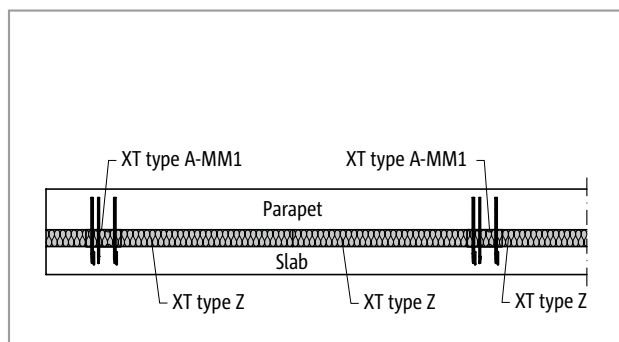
Schöck Isokorb® XT type A, Z: Attic (XT type A-MM1)
